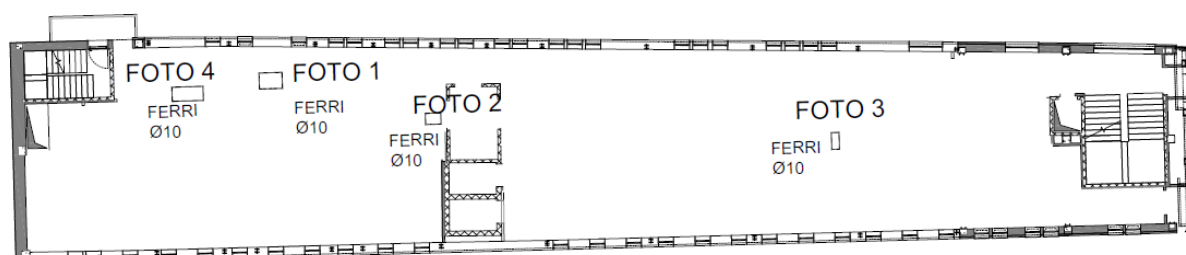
Pianta piano 4° - indicazione punti di presa fotografici.
